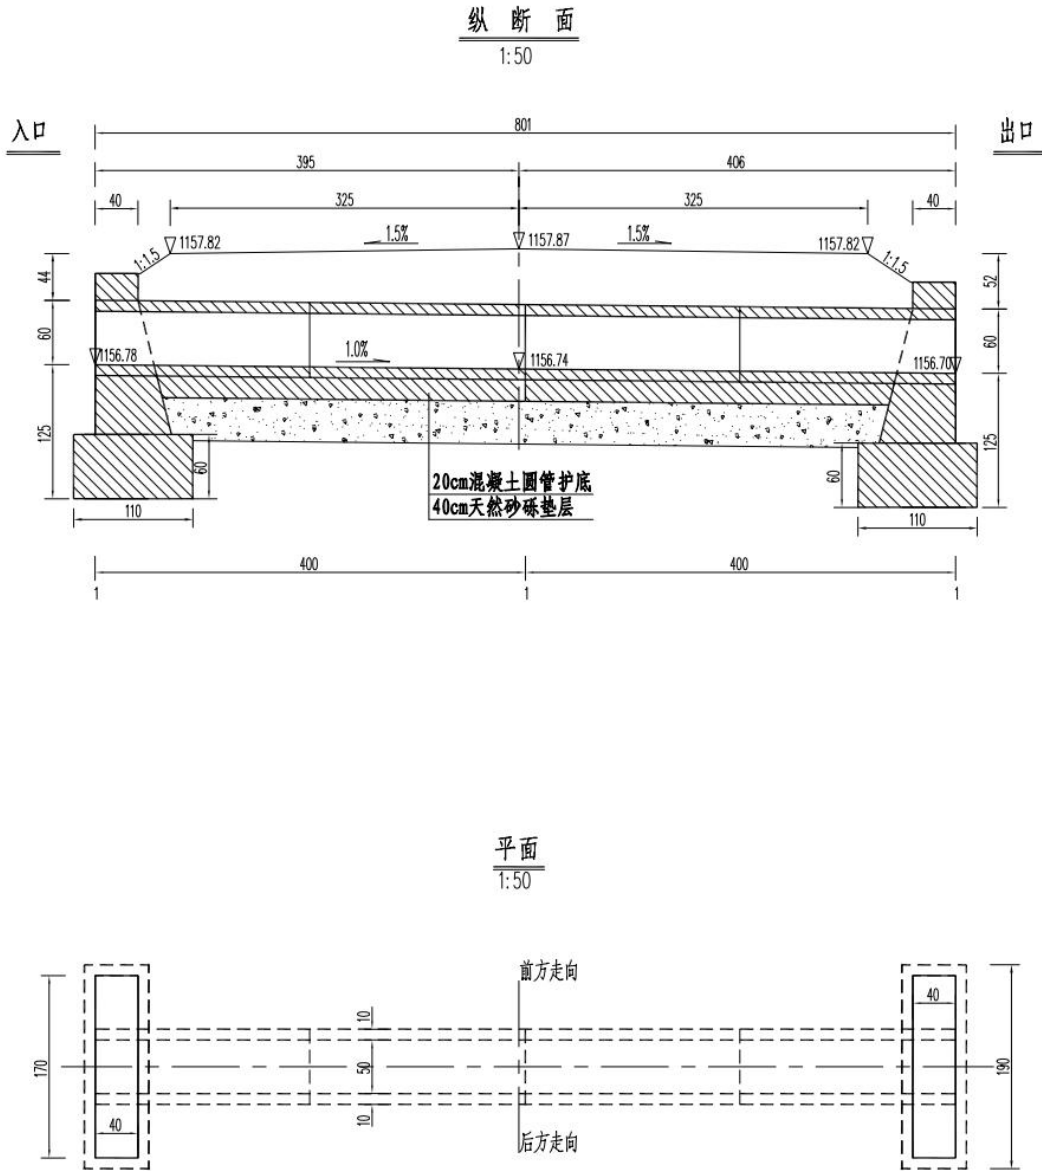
1-0.5m 钢筋混凝土圆管涵布置图
